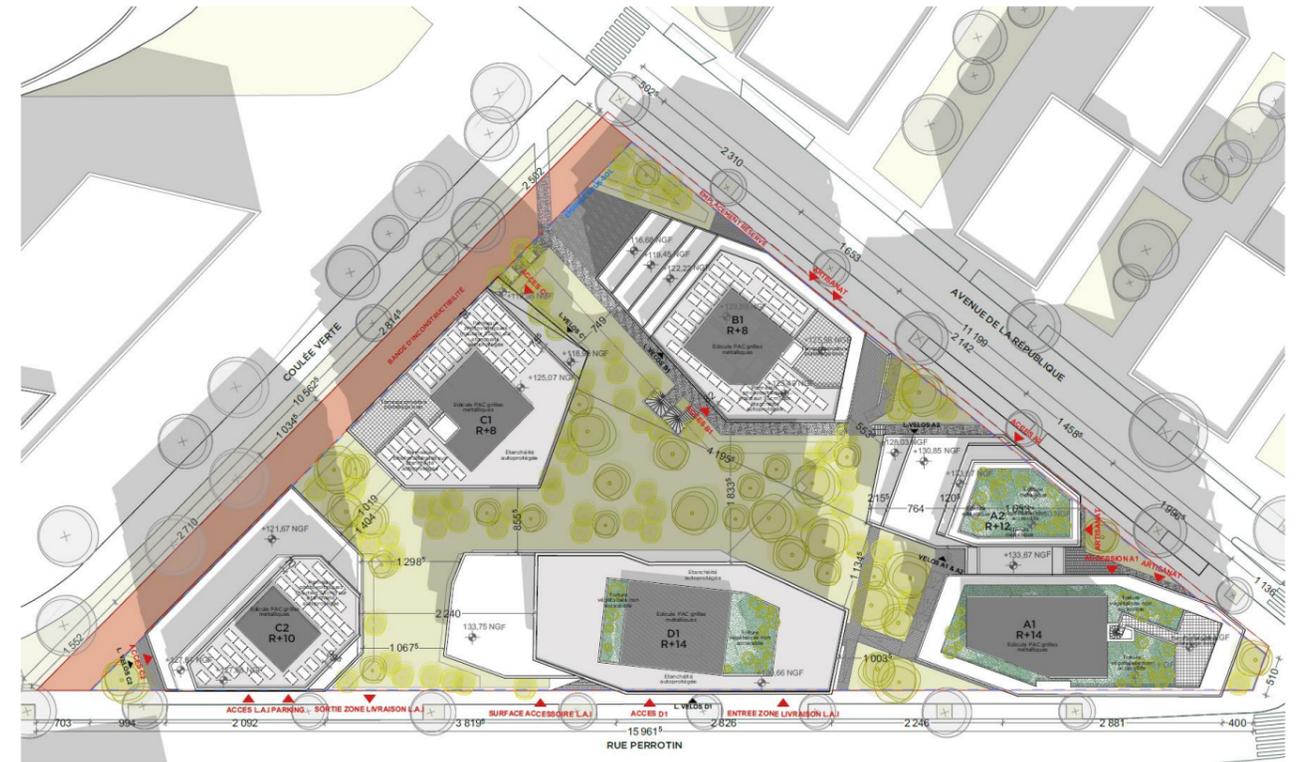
Plan masse du projet Vecteur Sud (Source : PC 02.1 Plan masse des constructions, permis de construire, PPX Architecte, octobre 2024)
